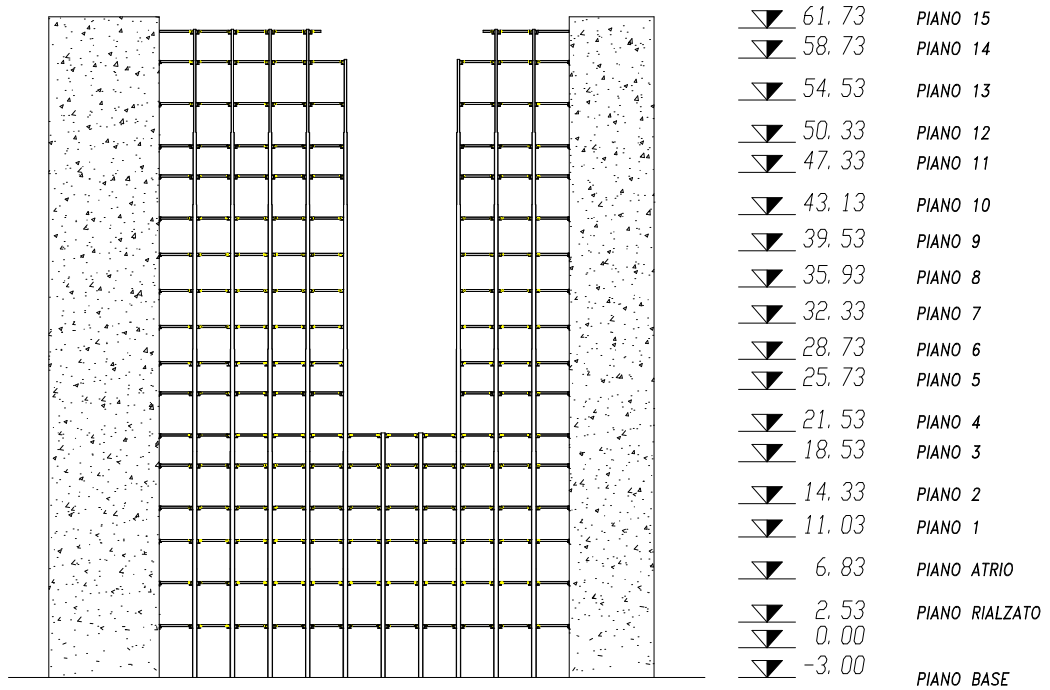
Prospetto longitudinale (N-S) del Corpo D
